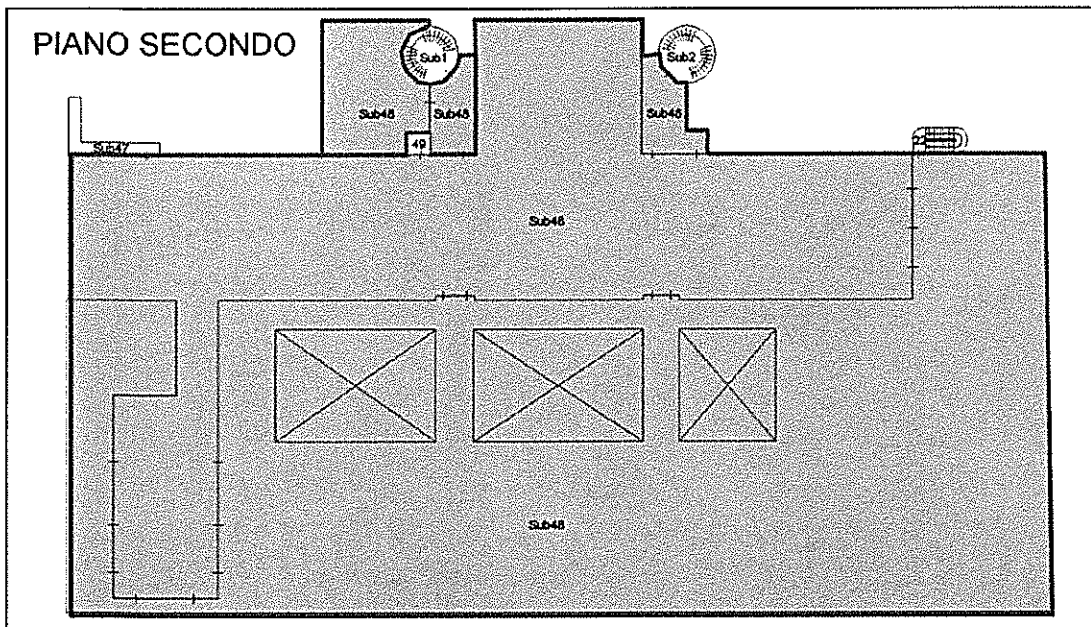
Elaborato planimetrico piano 2. Individuazione sub 48 (porzione).
